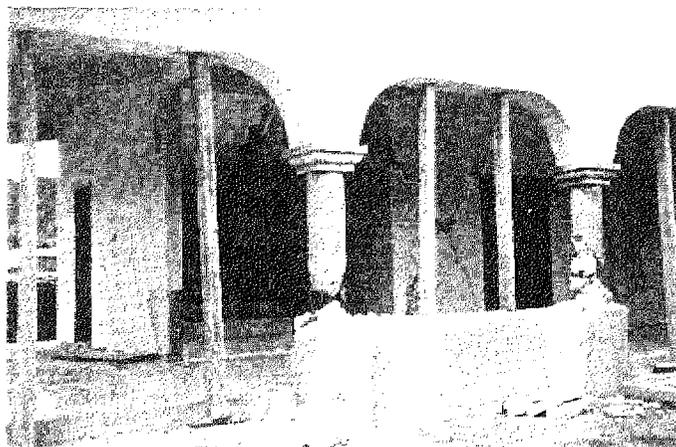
Daño en muros de mampostería y columnas de concreto
